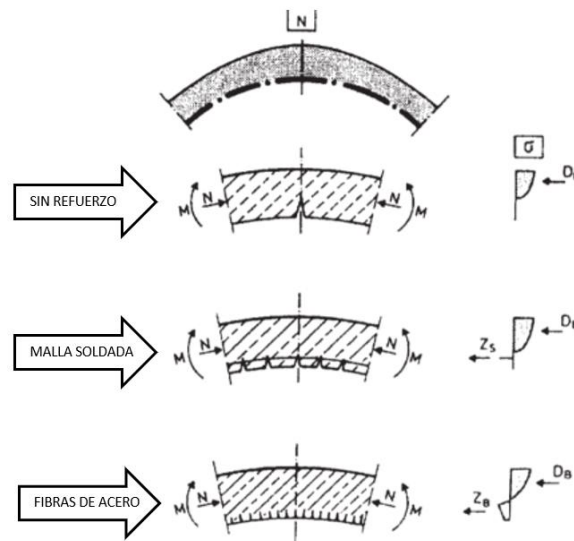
Comportamiento del revestimiento de concreto en túneles (de arriba para abajo): sin refuerzo, con refuerzo continuo y refuerzo discontinuo [15].
